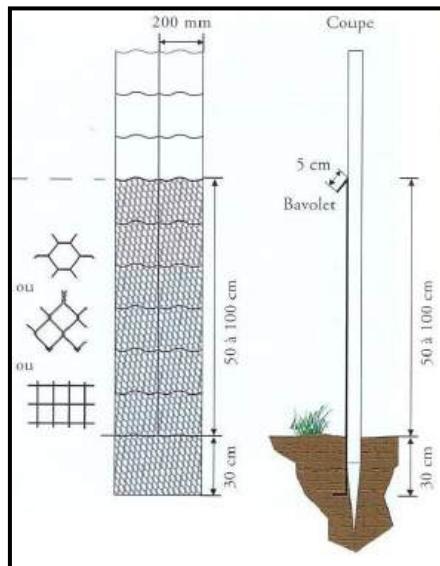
Grillage à petite section de type 6 (source : SETRA, 2005)
